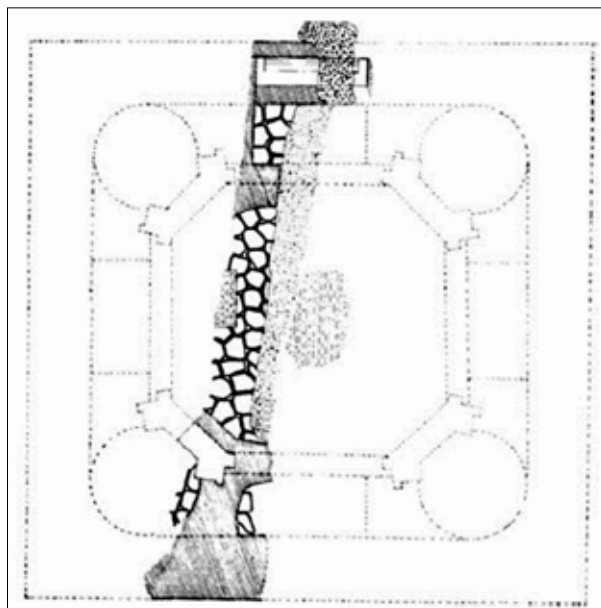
Pianta di sant'Ilario secondo BERTACCHI 1969.
